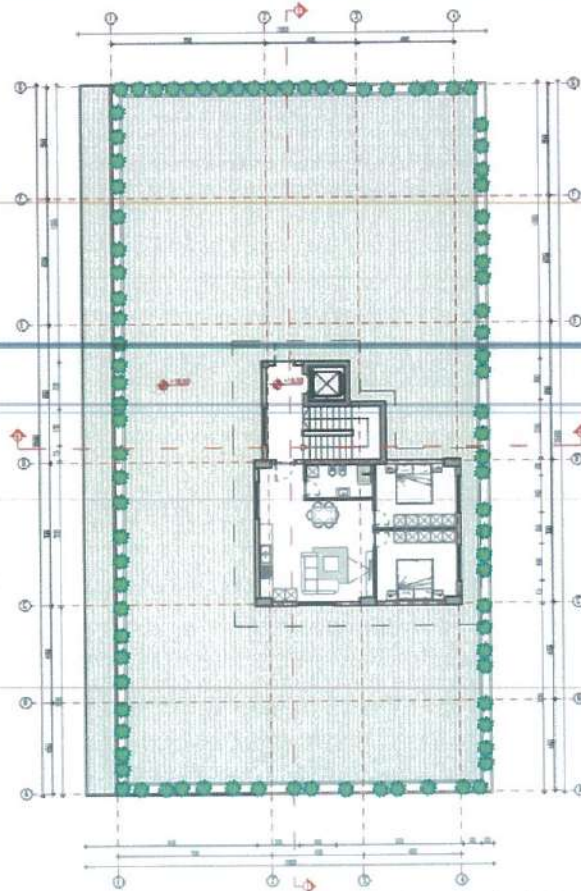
Planimetria e katit të gjashtë, objekti 3 & 4
